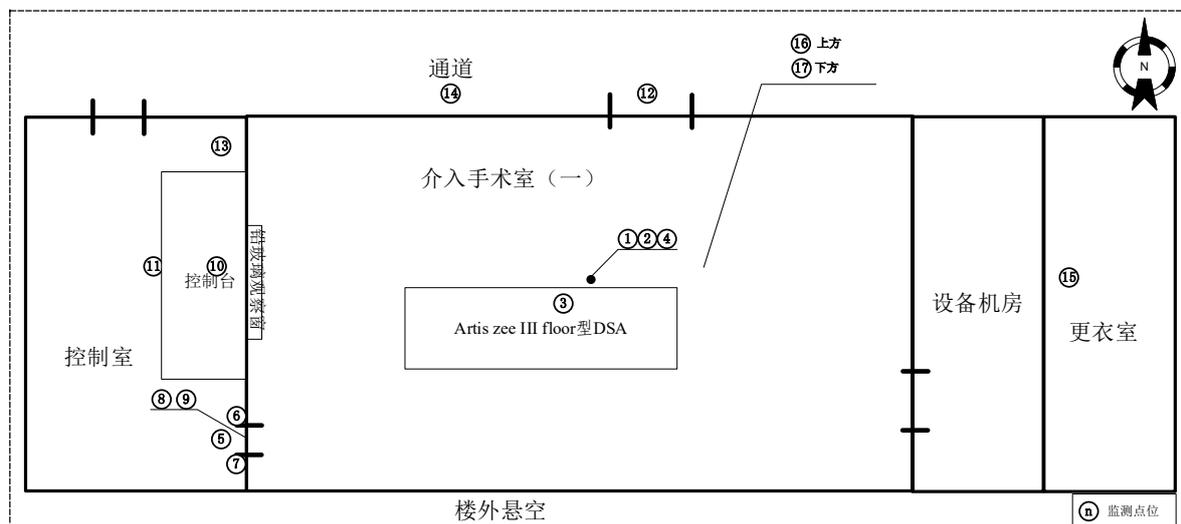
Artis zee III floor 型 DSA 应用场所监测点位布置图 (DSA 状态)
